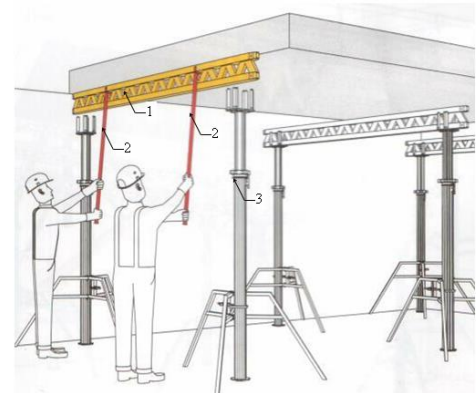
Демонтаж балок настилу опалубки: 1 - поздовжня балка; 2 - монтажних штанга; 3 - основна стійка
